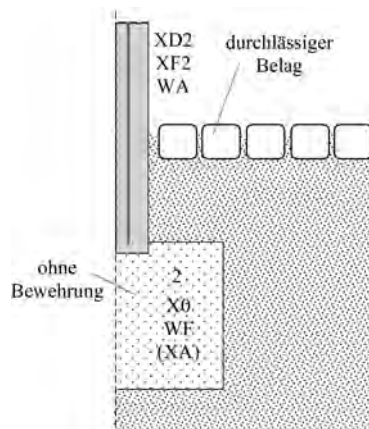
Bauteile unter durchlässigem Belag – abgedichtet
